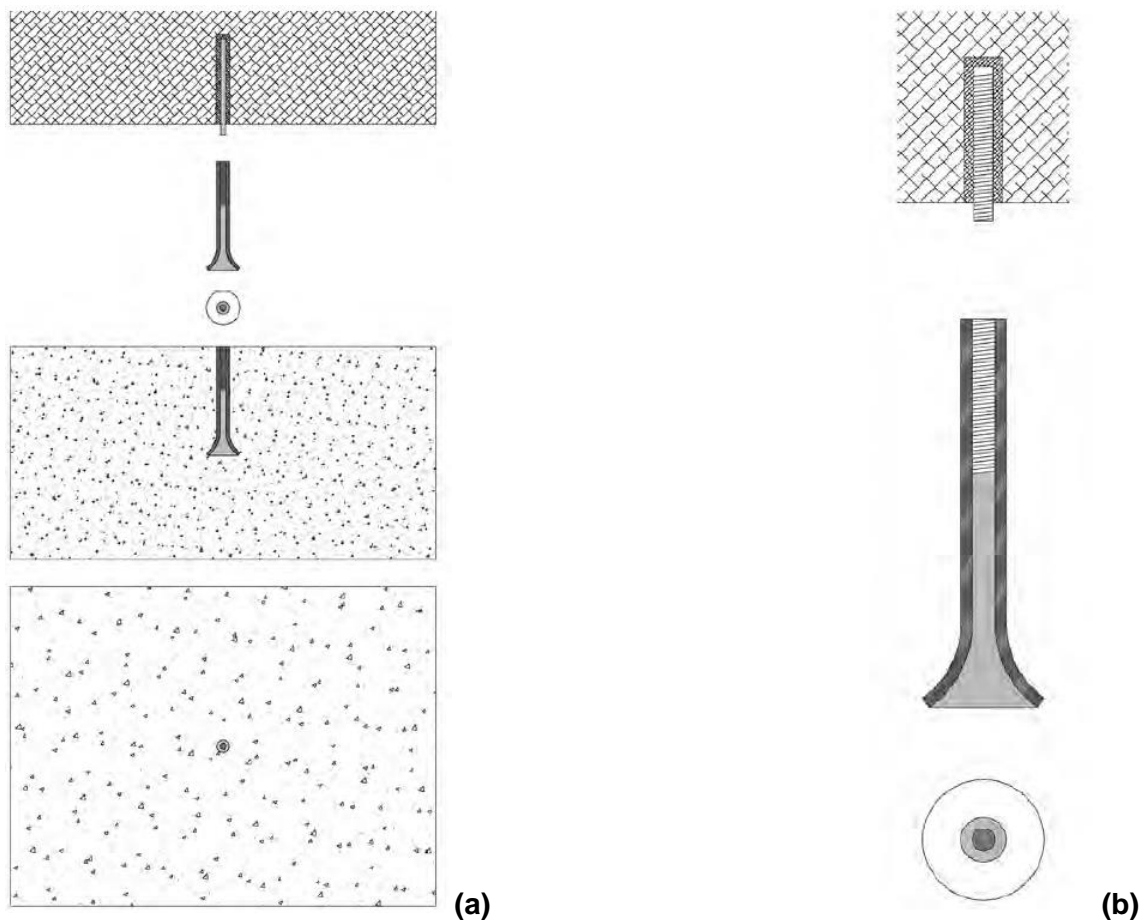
(a) Ancoraggio dell'isolatore alla platea di fondazione mediante barra filettata, vulcanizzata e fissata a tubolare filettato (sezione e pianta); (b) particolare della barra filettata vulcanizzata nell'isolatore e avvitata a tubolare filettato in acciaio *inox* (sezione e pianta) - Moussalli (2014).
